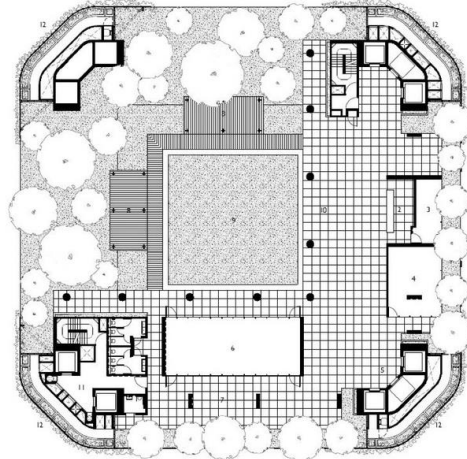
Denah Lantai 7 Oasia Hotel, Singapura
